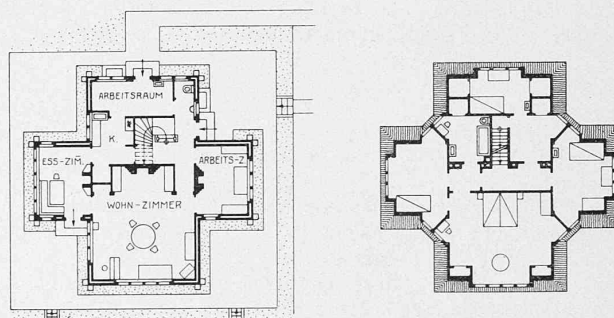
„De Kemphaan“ in Wassenaar. Grundrisse 1:400.
